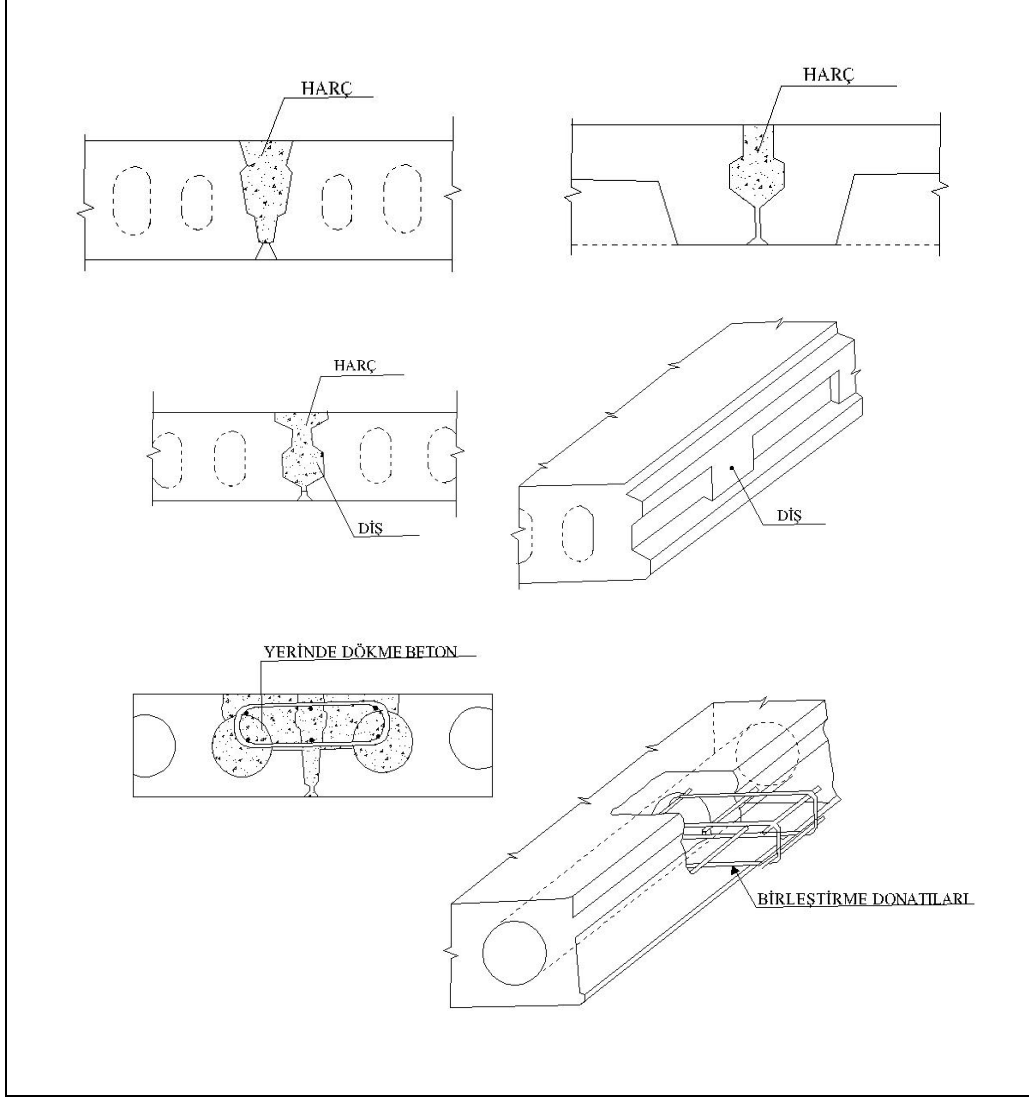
Donatılı üst betonsuz fiyonglu plak-plak birleşimi [14]
